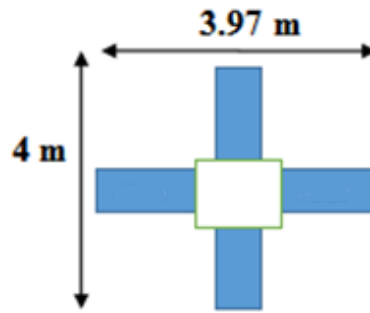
Surface de plancher reprise par le poteau le plus sollicité
